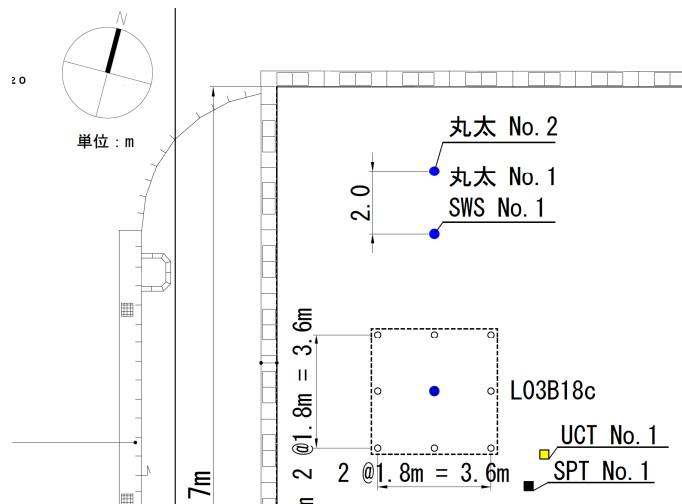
配置図と地盤調査位置（SS地点：佐賀県佐賀市）
